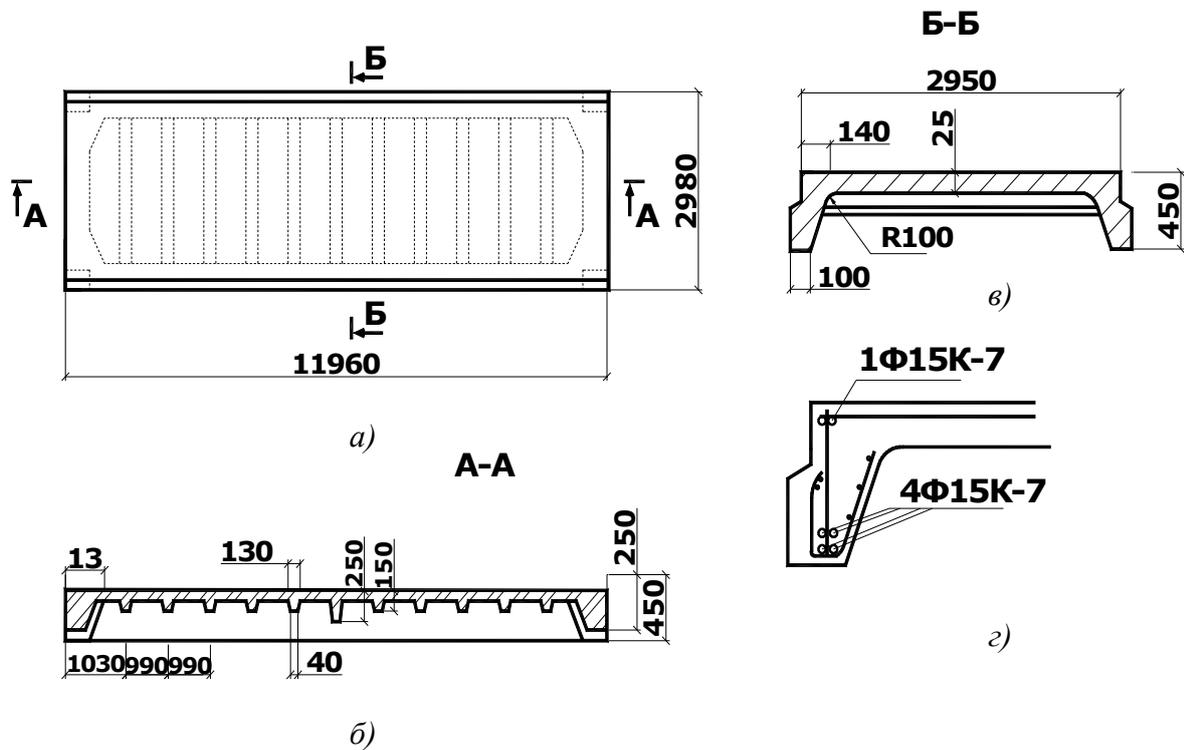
Ребристая плита покрытия размером 3×12 м: а – вид сверху; б – продольный разрез; в – поперечный разрез; г – схема армирования
